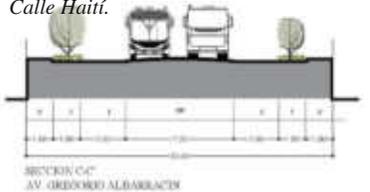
Sección Transversal de la Av. Gregorio Albarracín.
